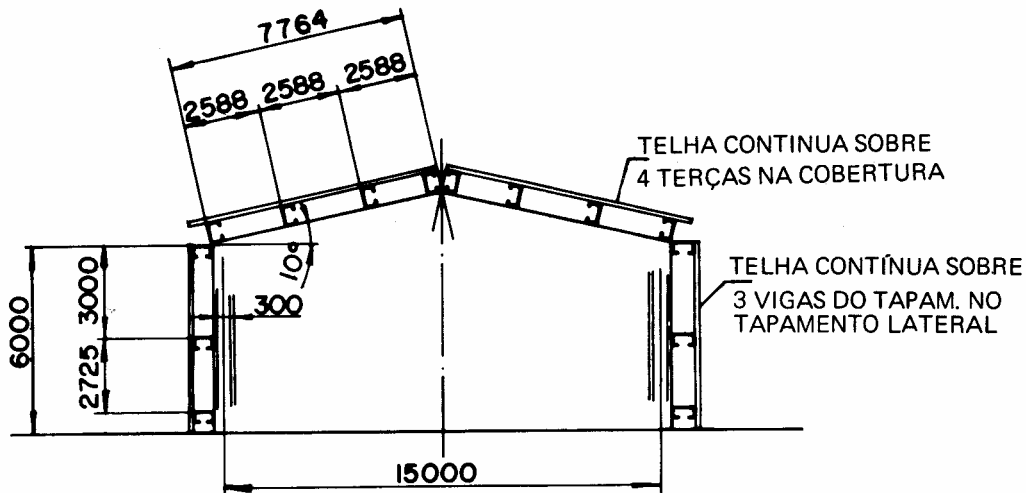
Distribuição das terças da cobertura e vigas do tapamento lateral
